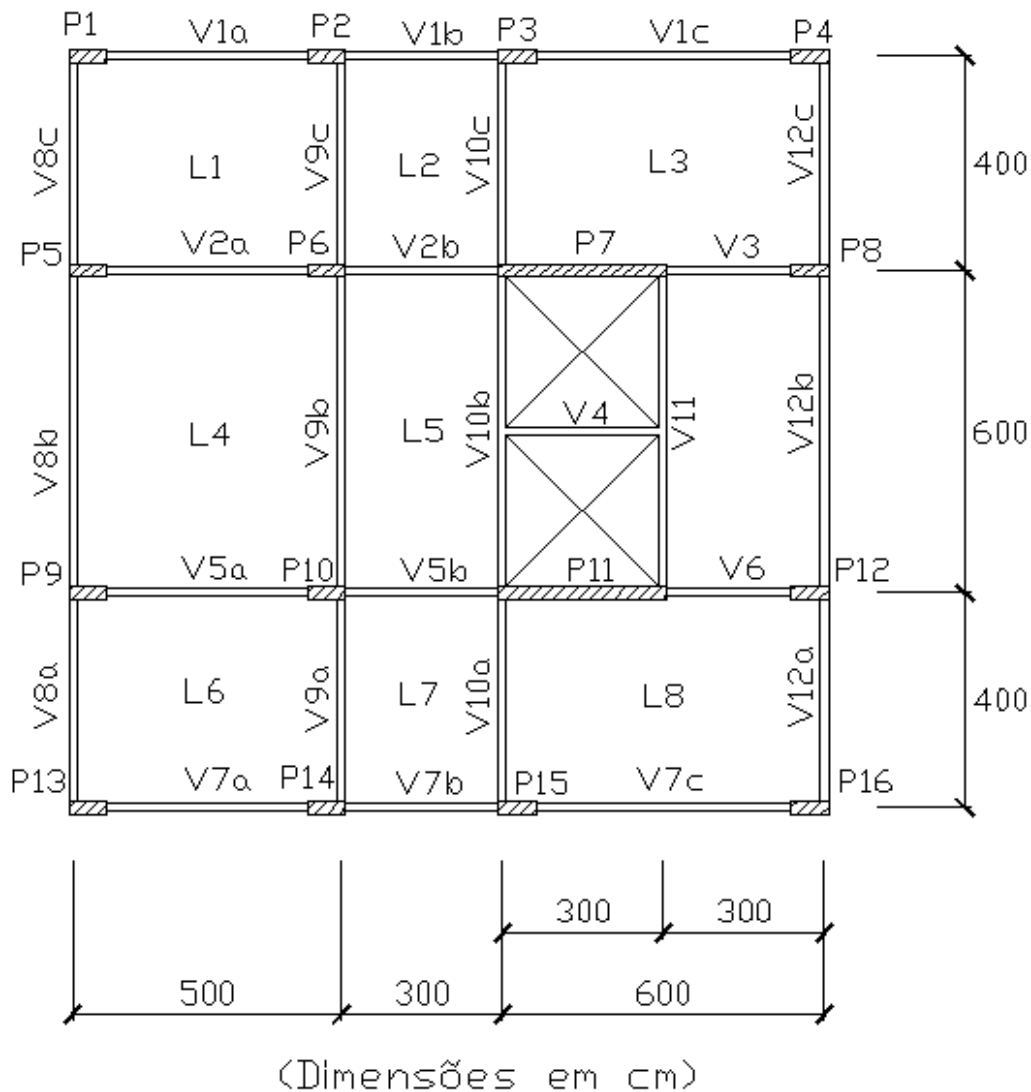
Planta de fôrmas do pavimento tipo (sem escala)
